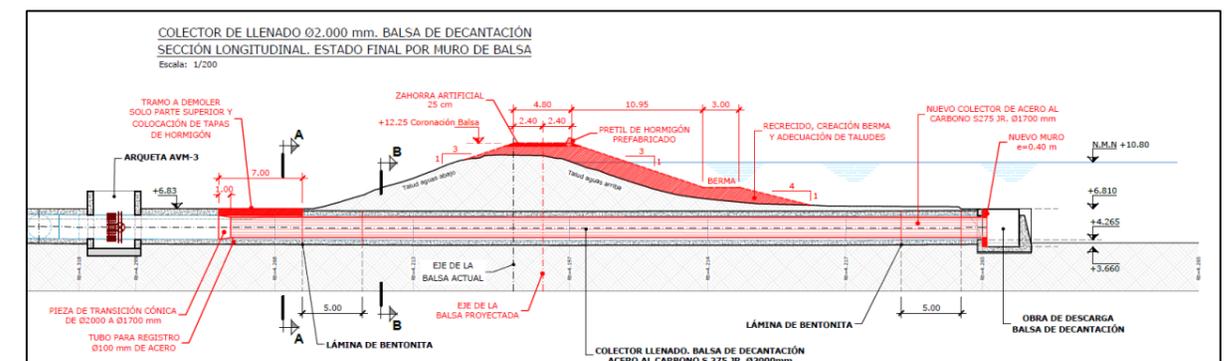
Perfil longitudinal de colector de llenado de balsa de Decantación. Balsa Belmonte
